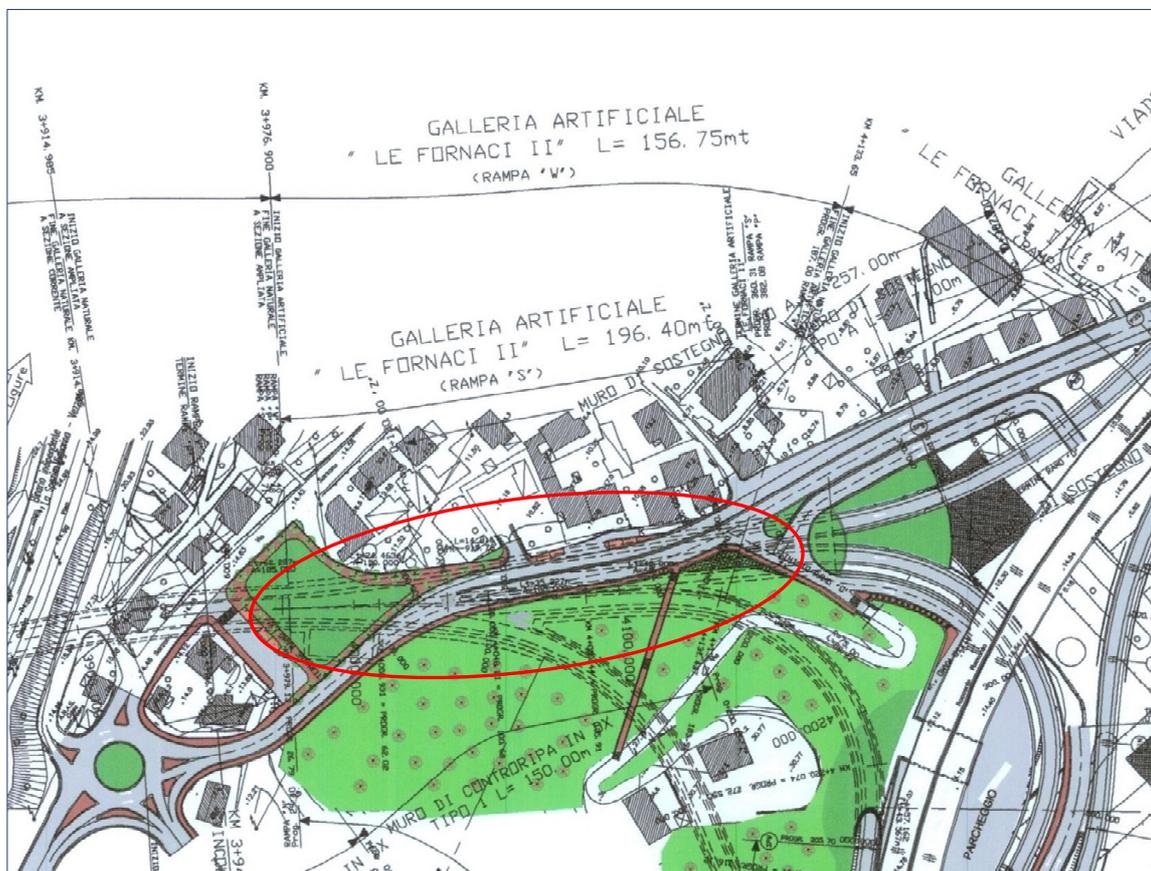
Galleria artificiale Fornaci II – Ubicazione planimetrica
